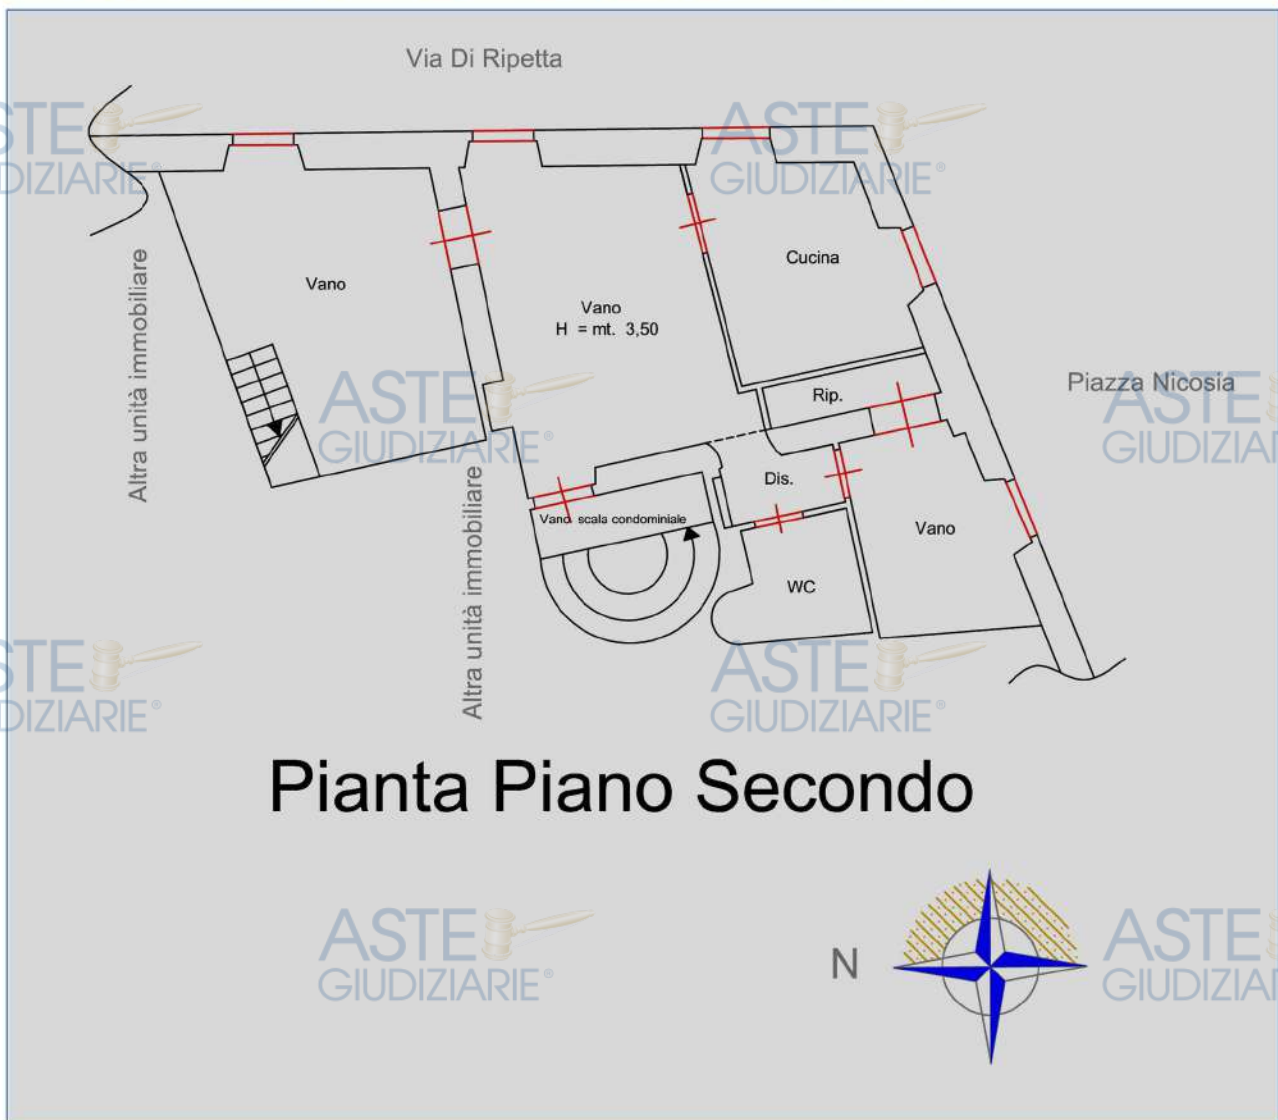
Visualizzazione della planimetria reale dell'immobile così come rilevata dal sottoscritto CTU
